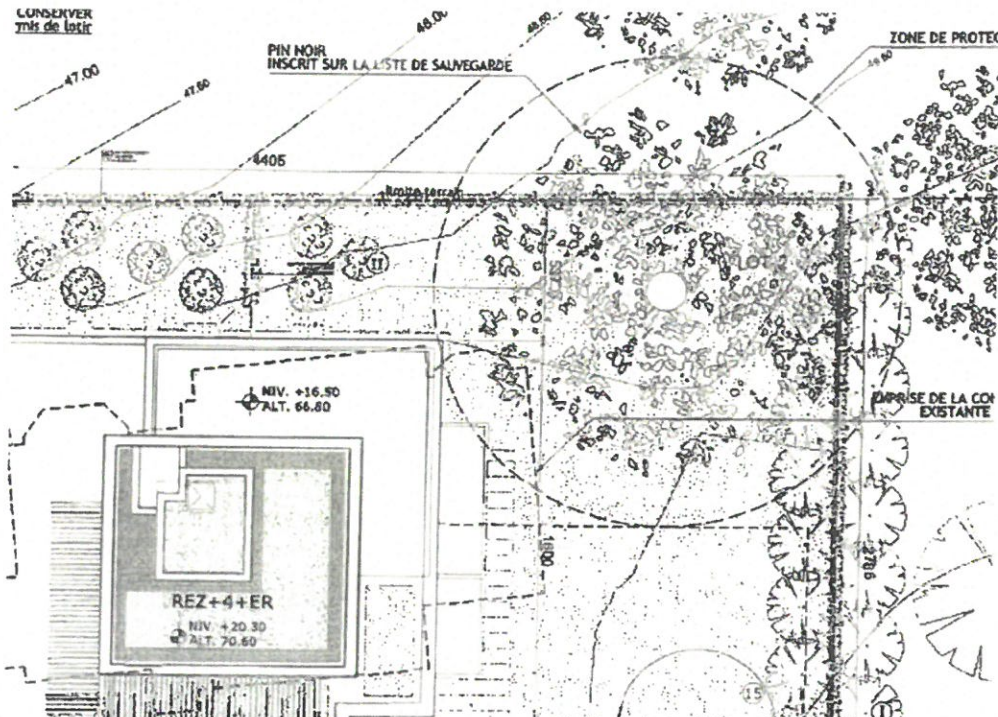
extrait du plan de situation projetée. Implantation du bâtiment existant et du futur parking souterrain (pointillés). Dimensions de la couronne du pin erronées.
